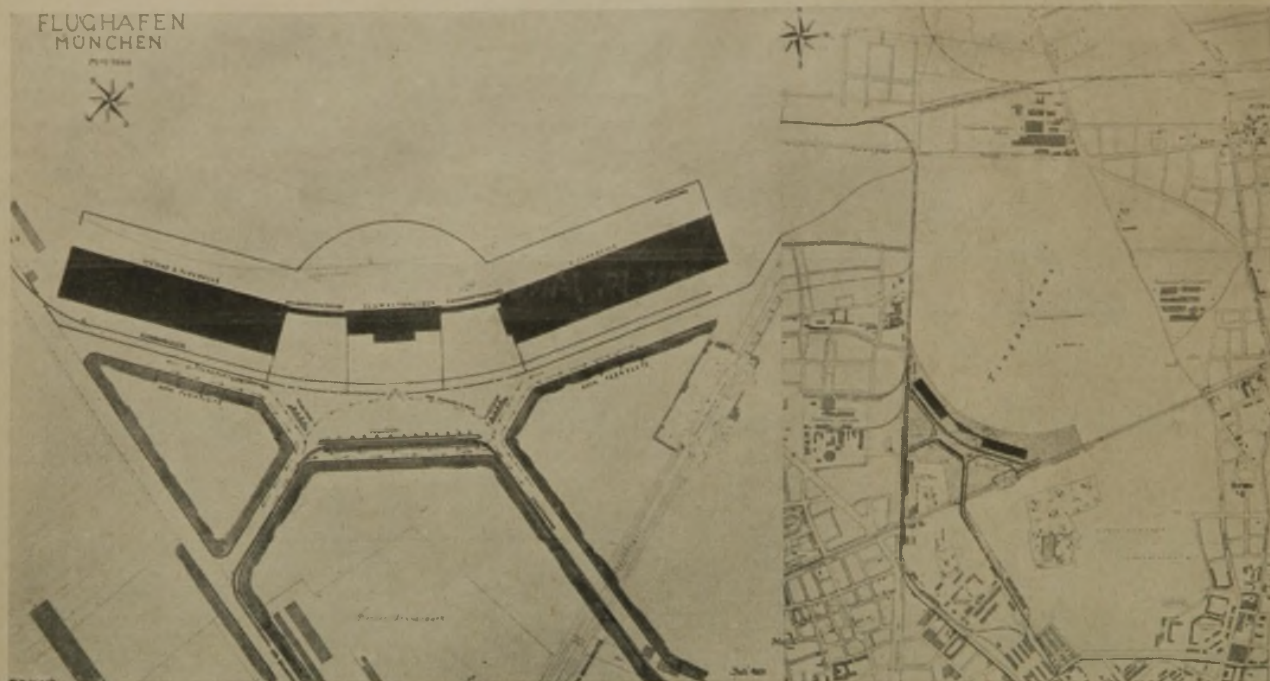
Teilplan mit den Bauten (1 : 8000).
